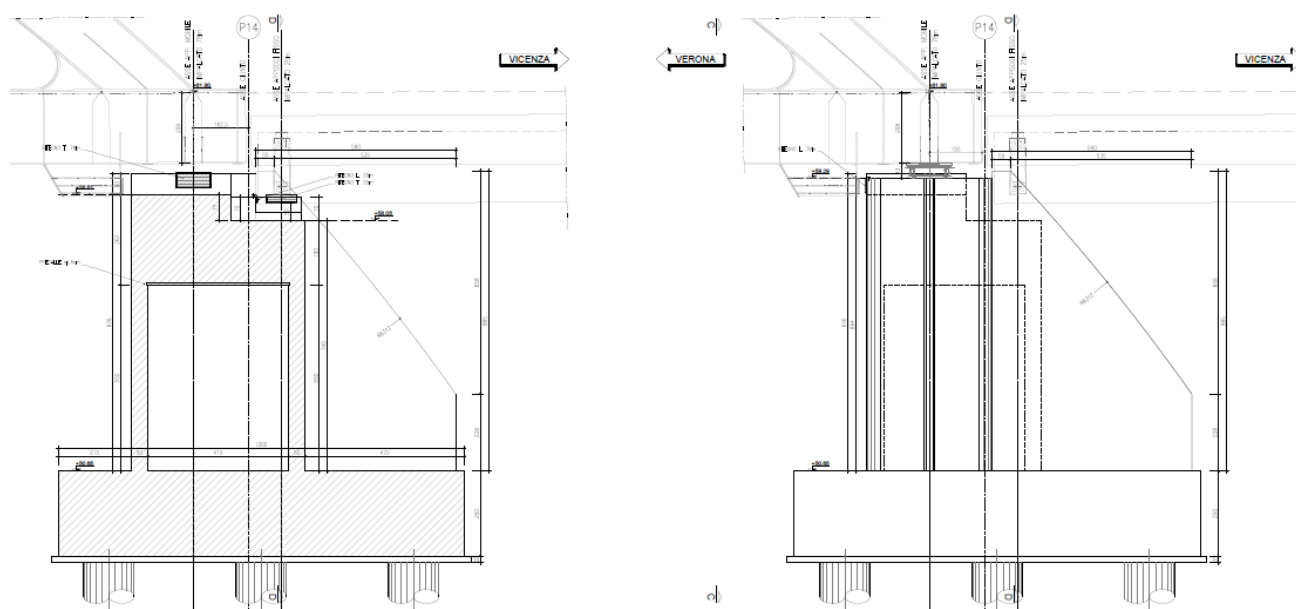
Sezione (a sinistra) e prospetto (a destra) longitudinali rispetto all'asse del viadotto
